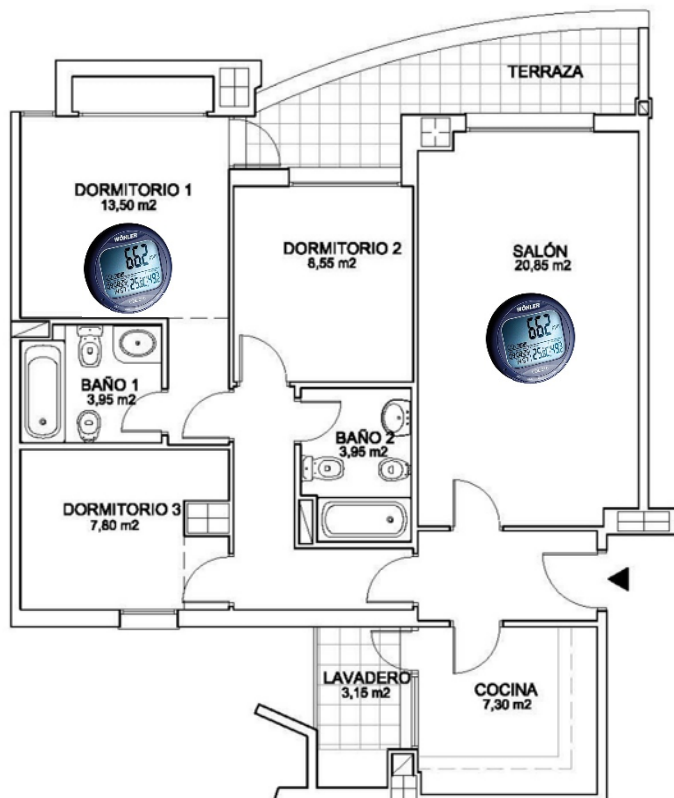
Planta tipo de las viviendas con la ubicación de los dispositivos.
